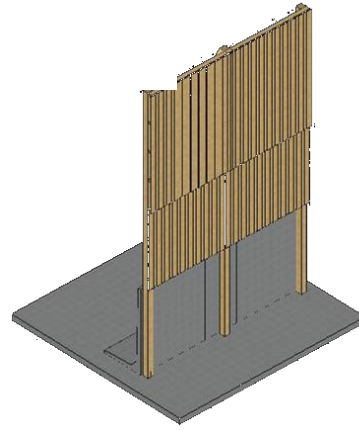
La structure avec le soutènement en L béton préfabriqué de l'extérieur
